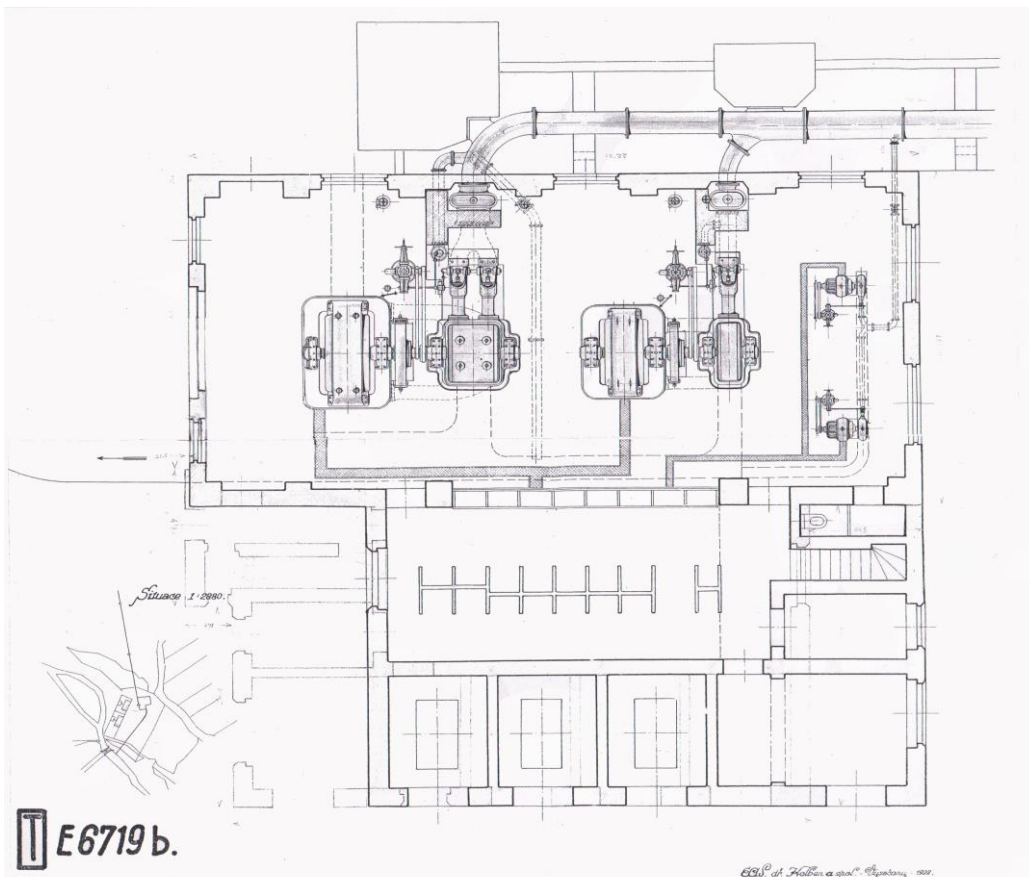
Strojovňa parnej elektrárne v Handlovej.
